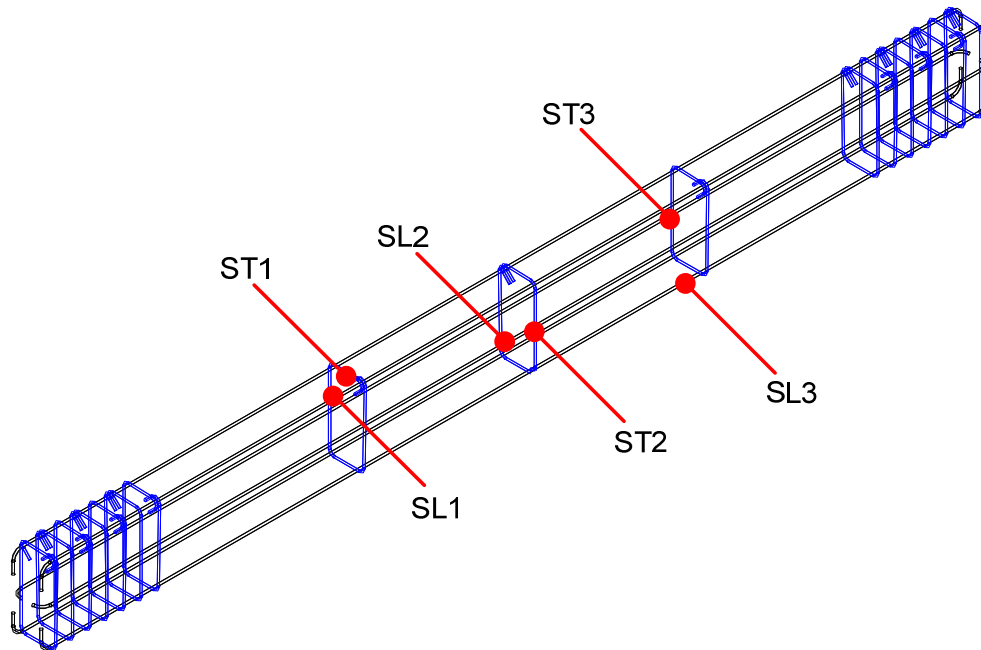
Posições da instrumentação executada nas armaduras.
